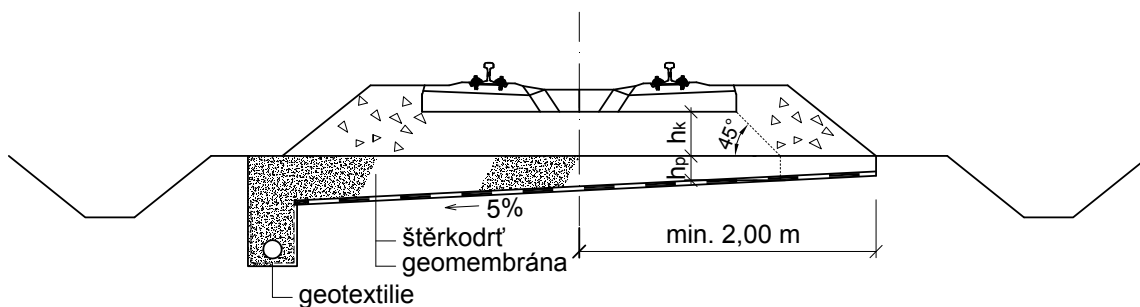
Jednokolejná trať v zářezu s betonovou deskou a geotextilií na zemní pláni
